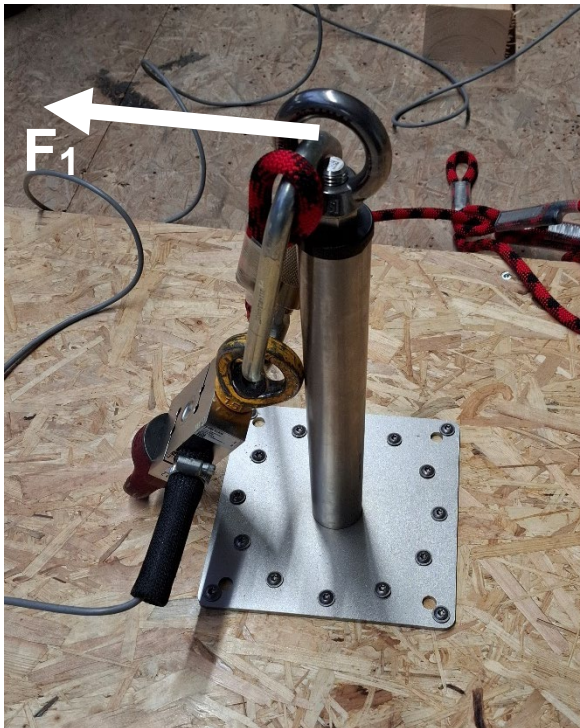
Prüfaufbau 1, Anschlagereinrichtung,
